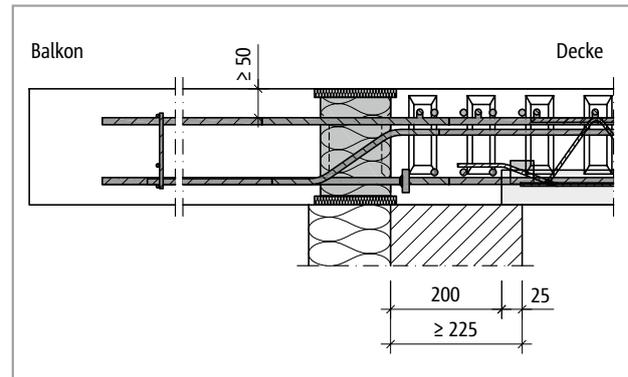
Schöck Isokorb® XT Typ C: Elementplatte ohne Randunterstützung mit WDVS (Schnitt XT Typ C-R-CV50, Ansicht XT Typ C-L-CV35)
